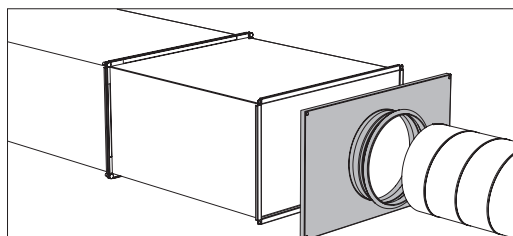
Installatie aan de muur, vloer of plafond
